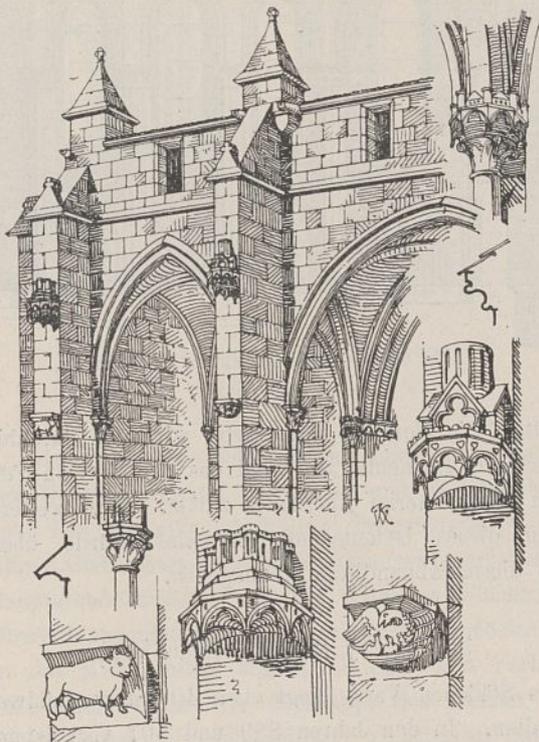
Liebfrauenkirche in Rougemont. Vorhalle mit Einzelheiten.
